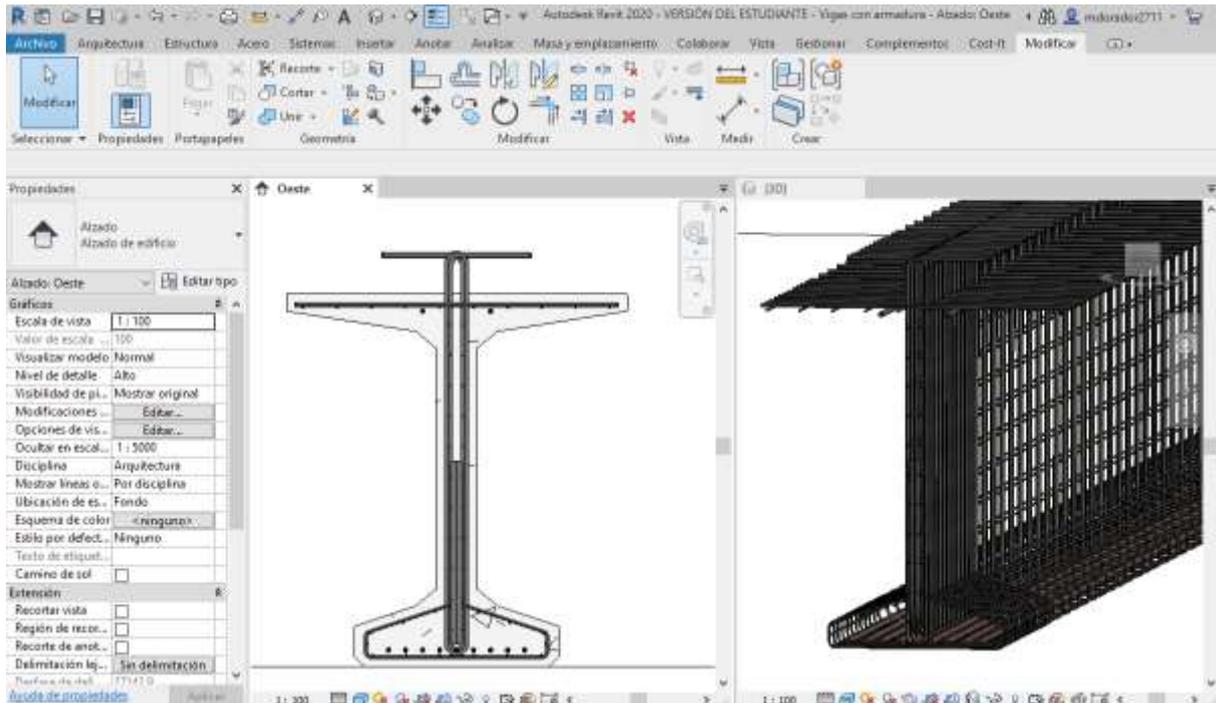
Introducción de armaduras en las vigas. Fuente: El. prop.
